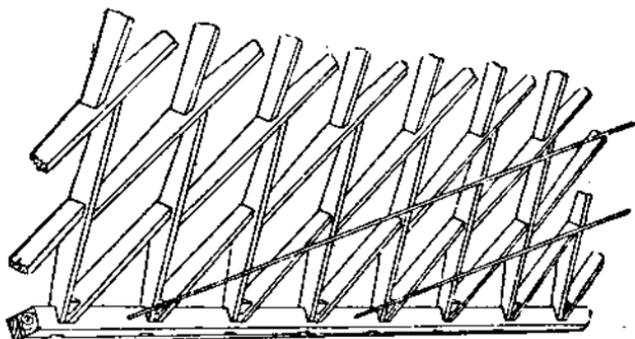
Мауэрлат, пробки и металлические затяжки.
